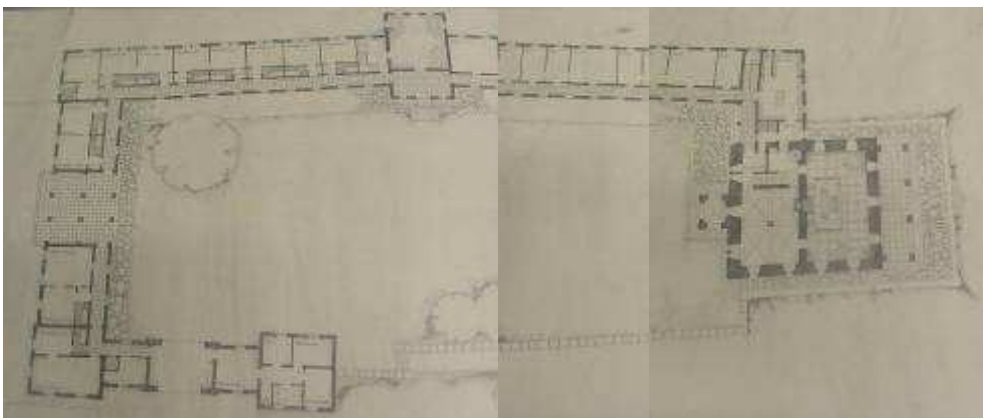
Otto Strohmayr und Otto Reitter, Grundriss, Schloss Fuschl, November 1939
